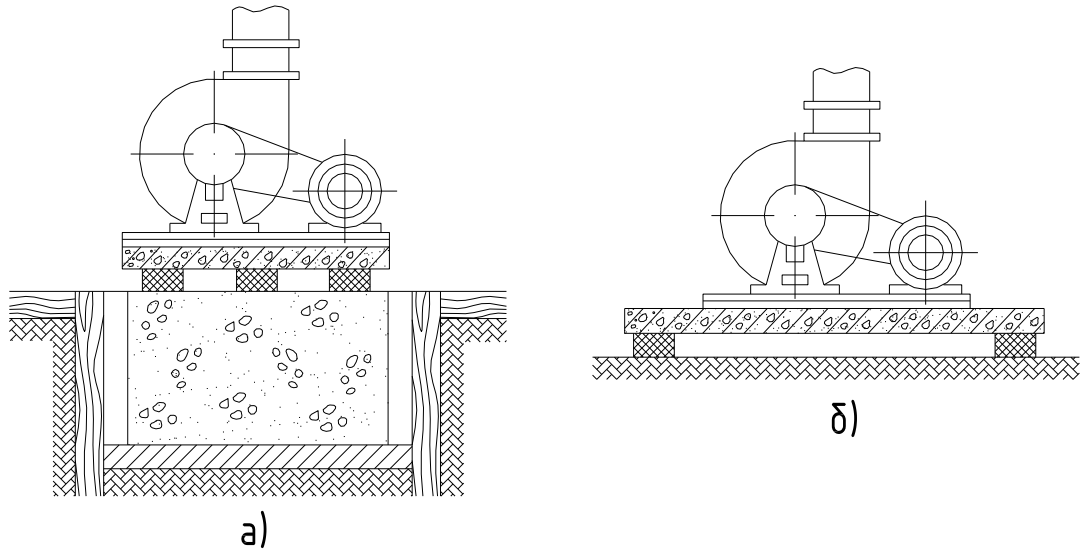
Схеми установки обладнання: а - на фундаменті та ґрунті; б - на перекритті
